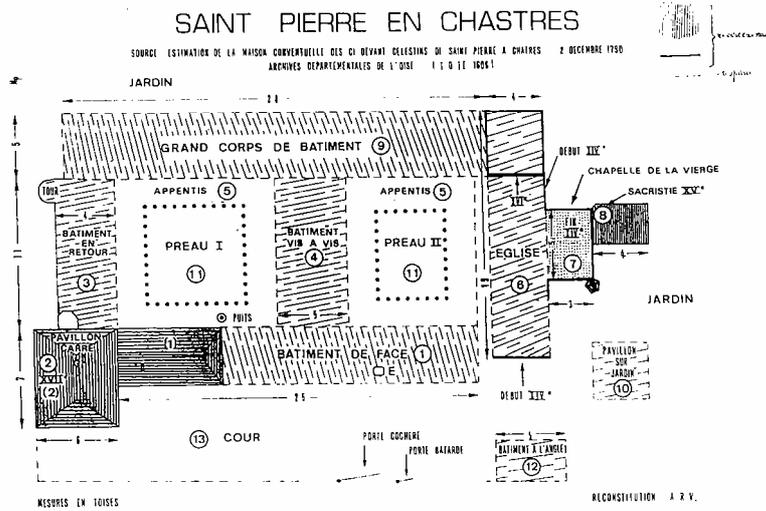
Saint-Pierre-en-Chastres - Plan du Monastère
